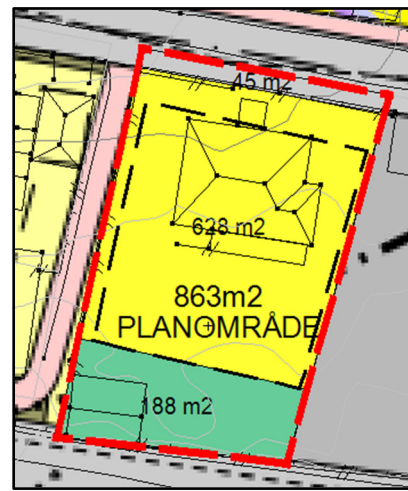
Planlagt bygg i gjeldende plankart. Planlagt bygg er illustrert med oransje farge.
